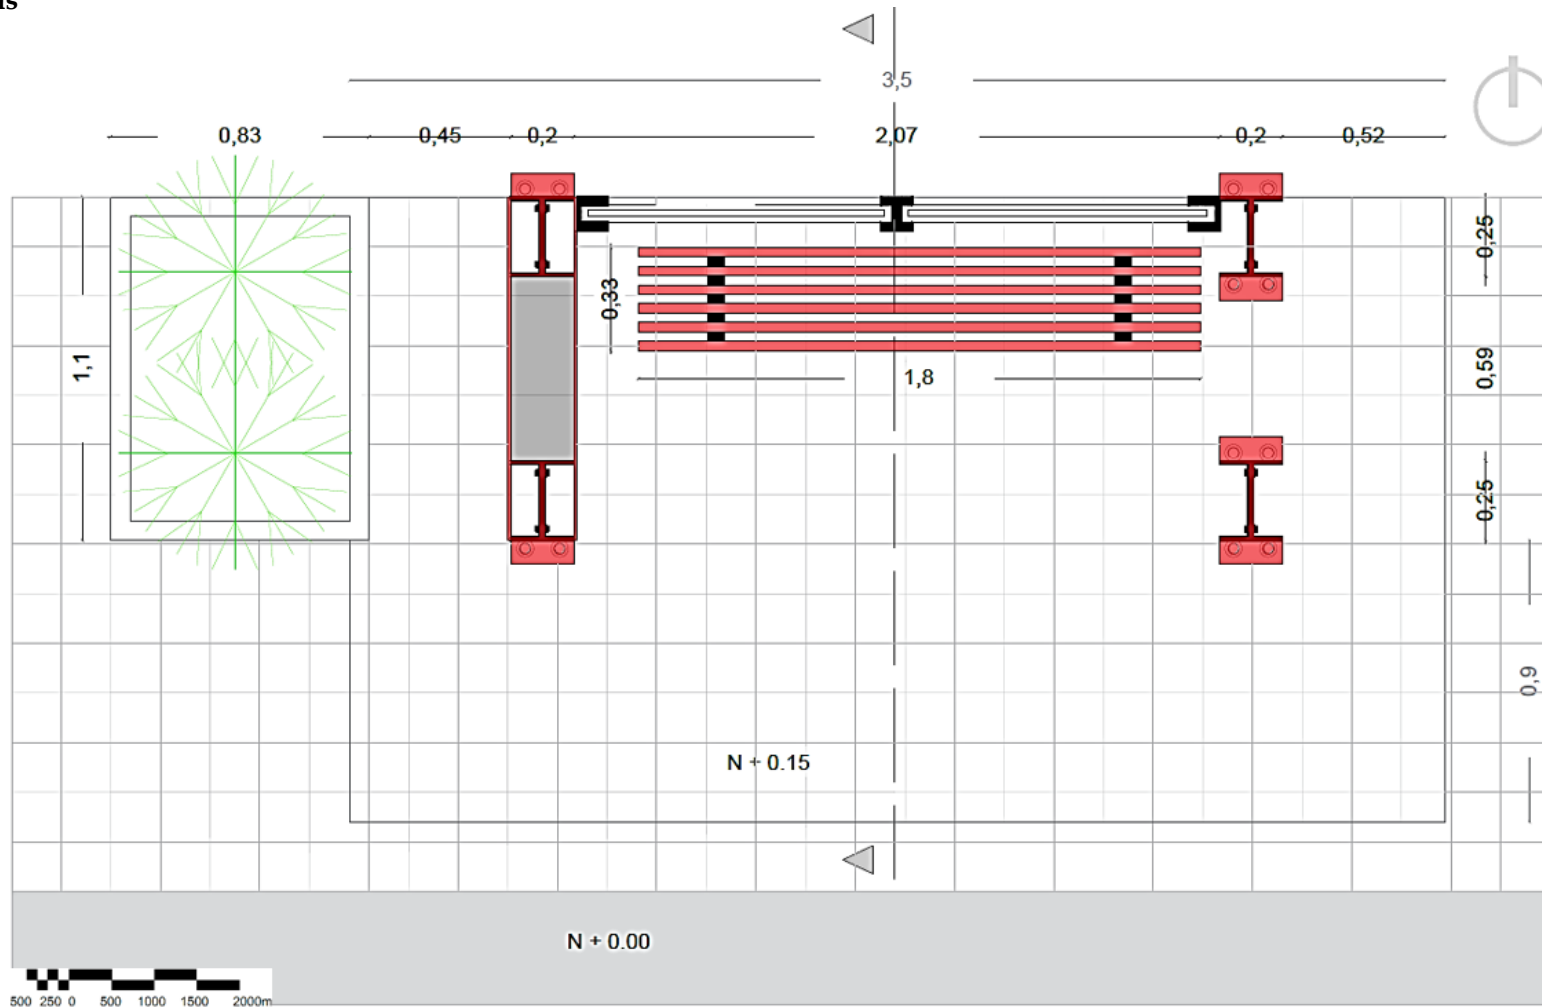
Planta del mobiliario de las paradas menos utilizadas, escala 1:25. Elaboración propia.
